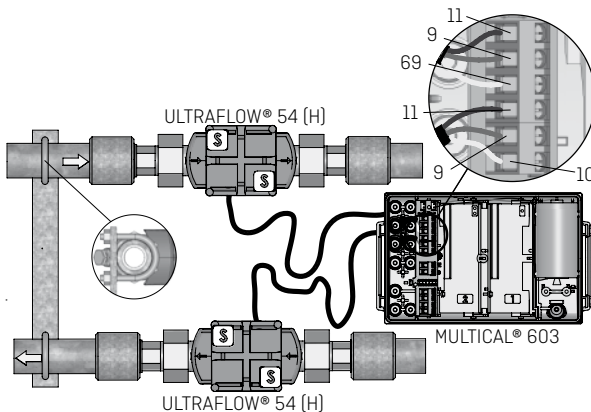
Vor- und Rücklaufrohre sind elektrisch dicht gekoppelt. Es gibt keine Schweißstellen.
